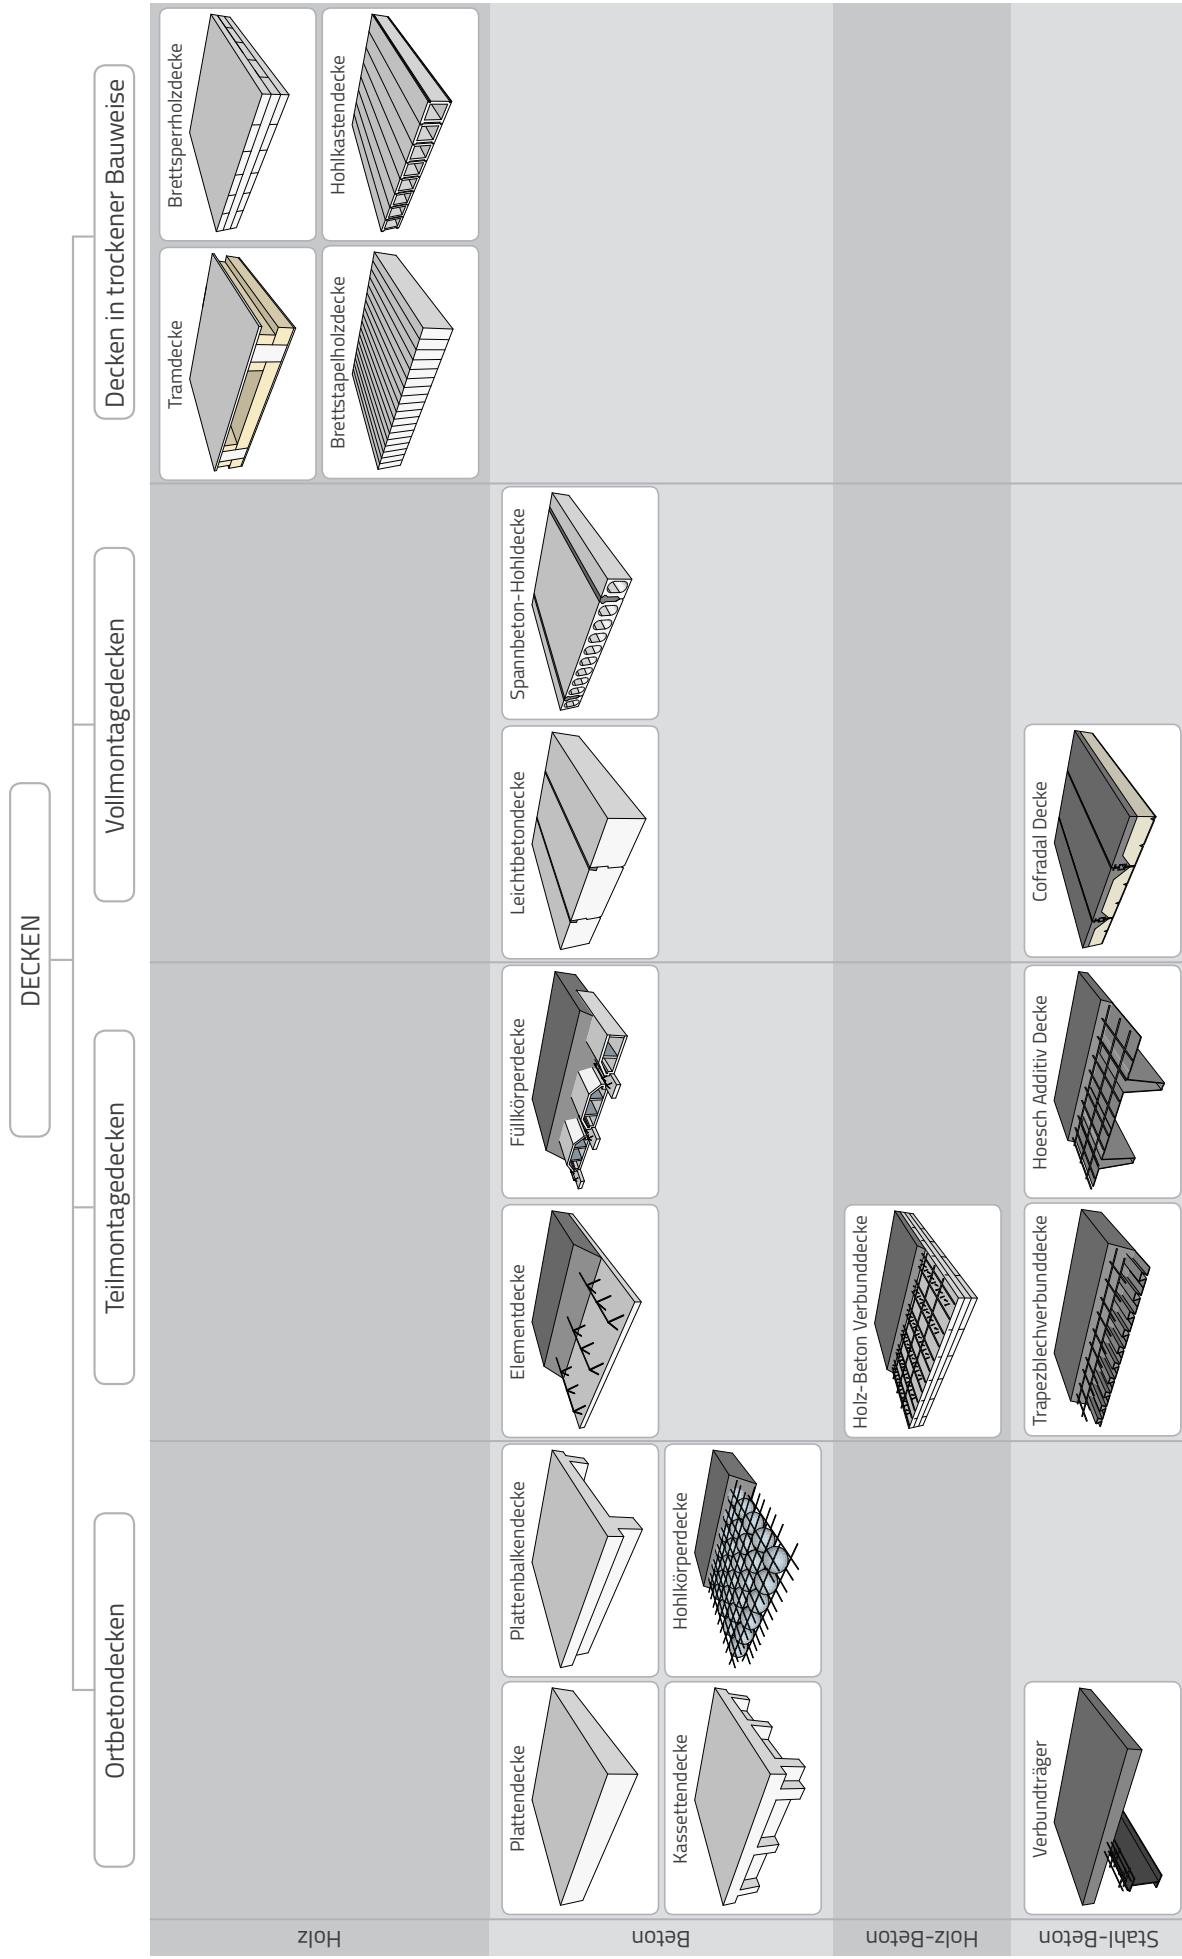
Einteilung der Deckenkonstruktionen nach Montageart
